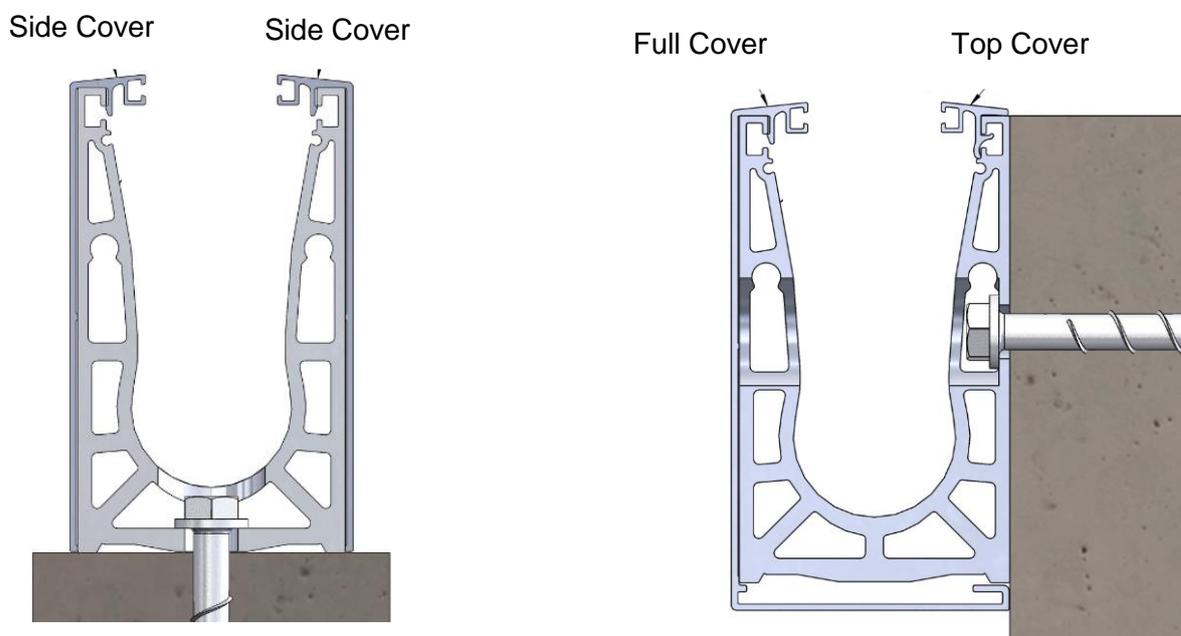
VetroMount Top con cubierta (para su montaje en el suelo)
